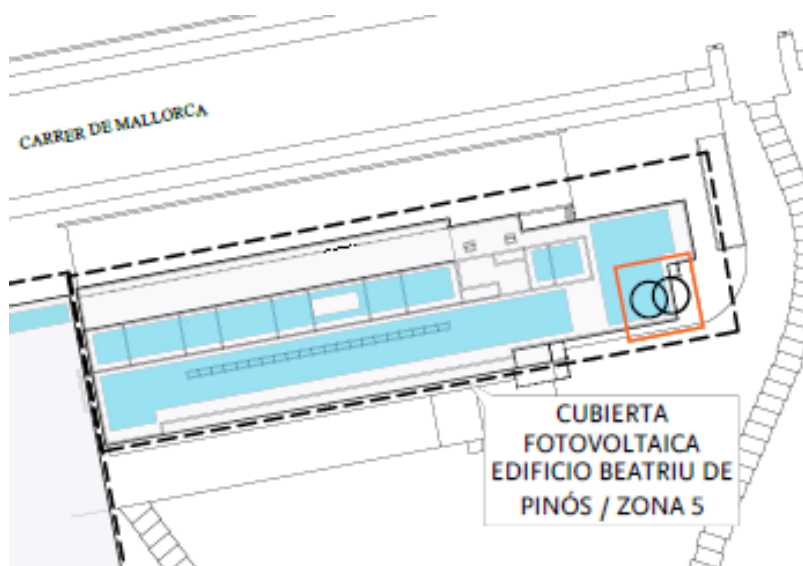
Disposición de las placas fotovoltaicas en la cubierta del edificio Beatriu de Pinós
